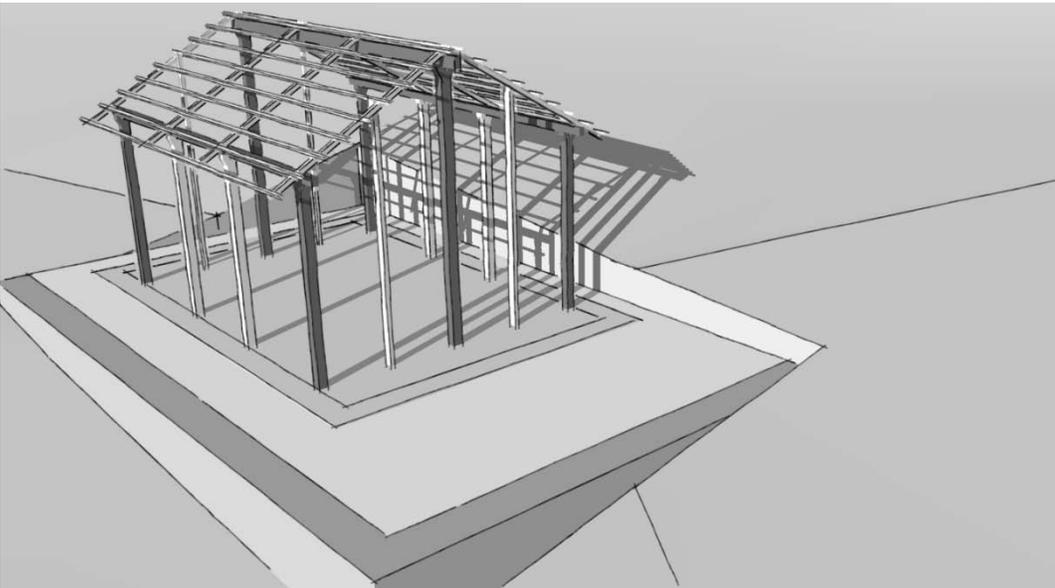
Colocación de la subestructura para tejer la techumbre (partida "Estructura del techo").
